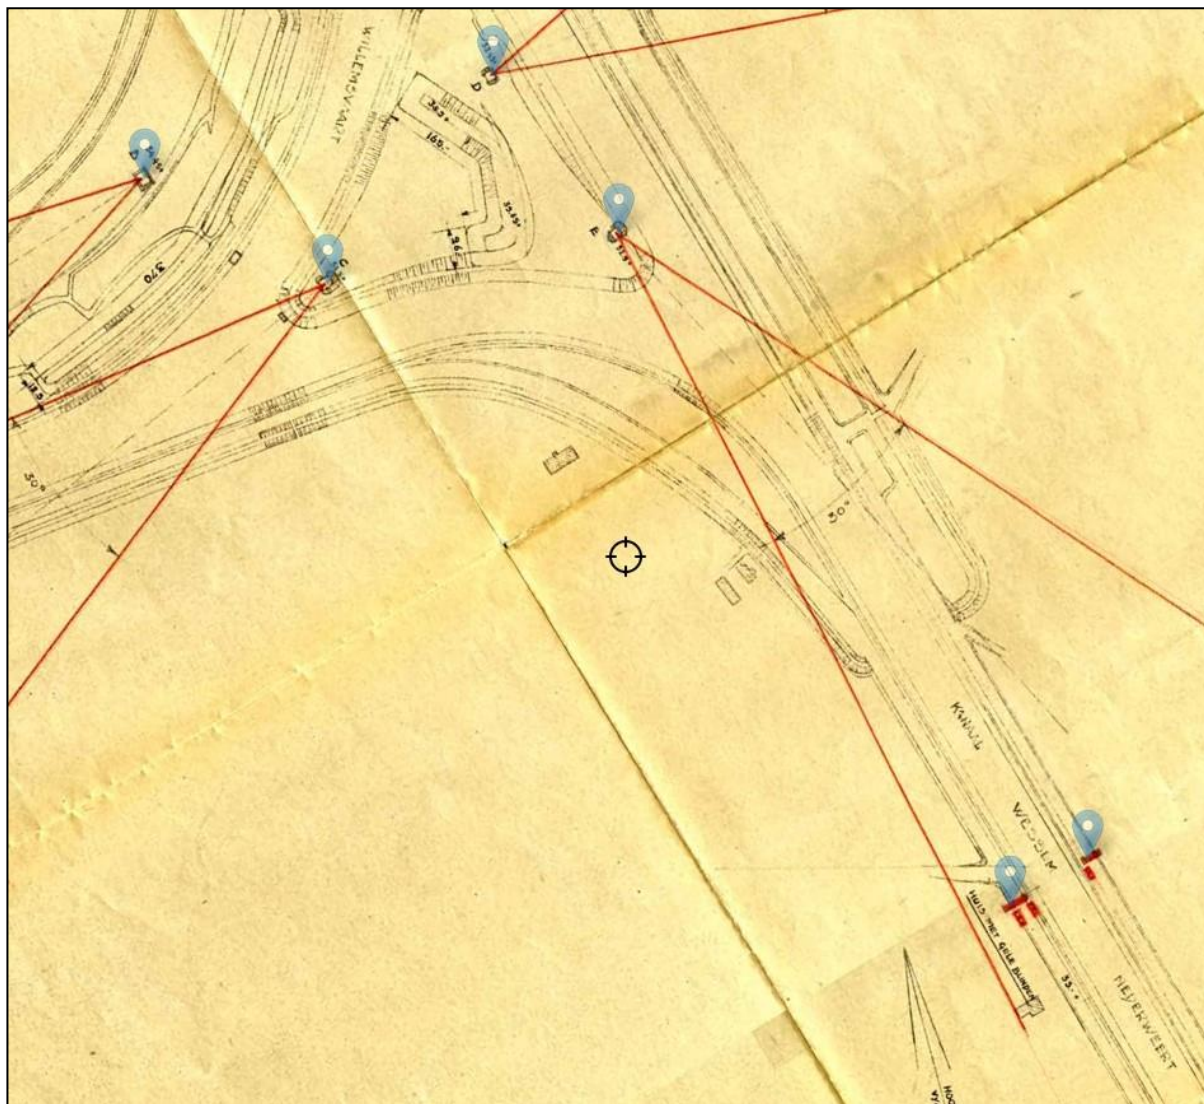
Zuidelijke deel van de kanalenkruising in Nederweert. Fragment van de vergunningstekening van de verdedigingswerken uit 1937. Rechtsonder (bij de blauwe punaises) de 'aspergestelling' van de Wessemerdijk. Ondergrond: Nationaal Archief, bewerkt door Jan Vos.
